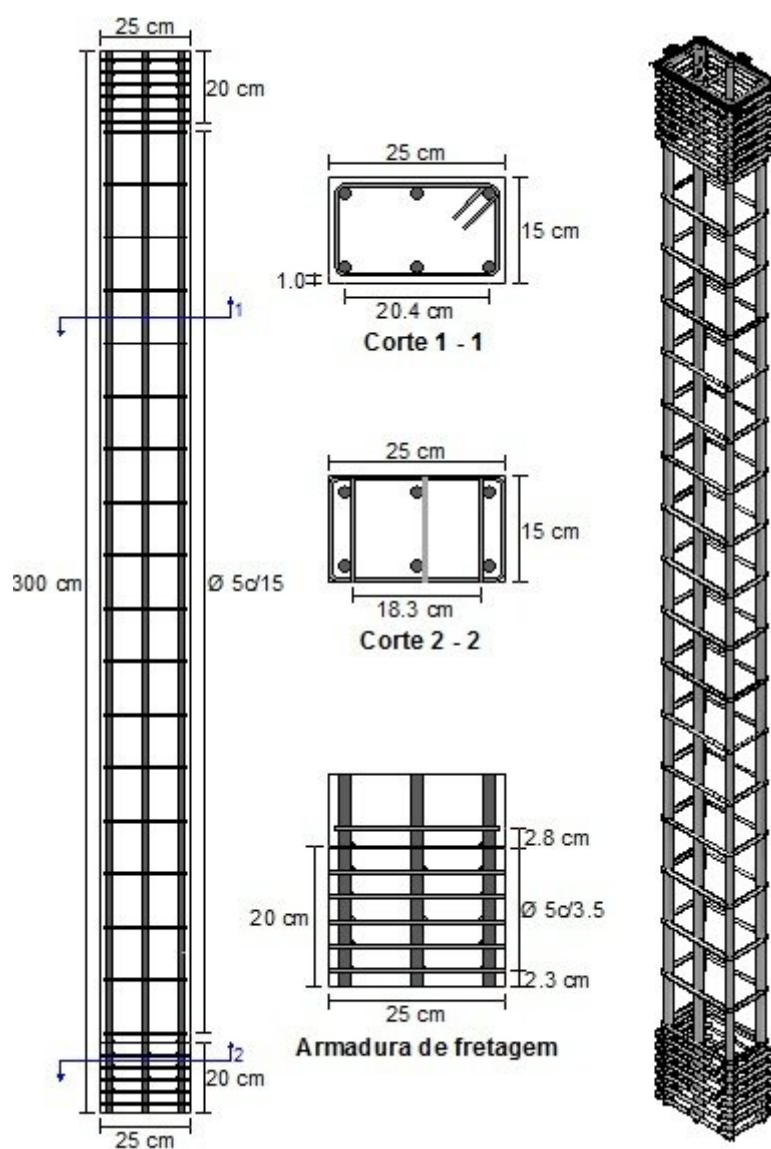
Detalhamento das armaduras dos pilares C40-3.2 e C80-3.2
